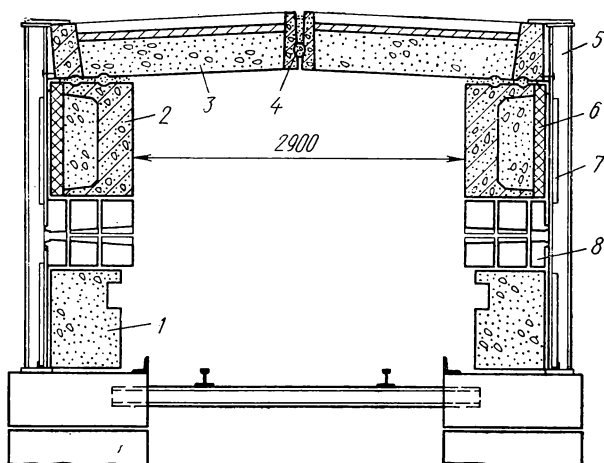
Конструкция туннельной печи из жаростойкого железобетона:
